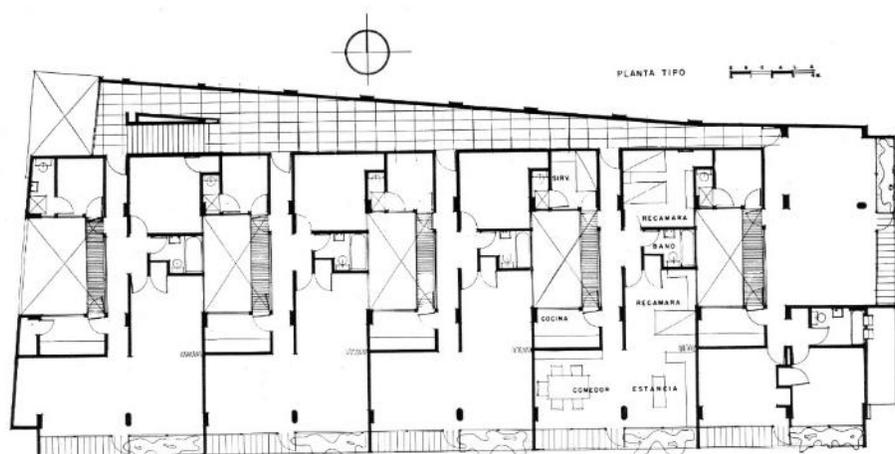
Planta tipo del edificio ubicado en Alfonso Herrera núm. 11, 1948
